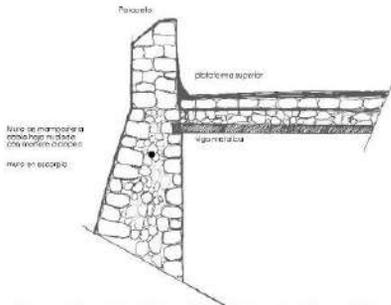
Detalle de muro perimetral fortificación militar Sisal Yucatán. Elaboración Karla Gómez 2018.
